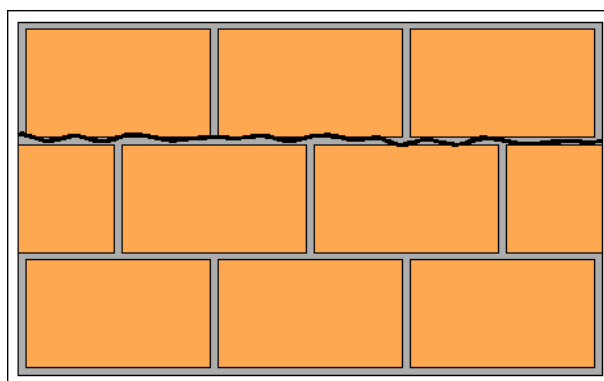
Fissuração horizontal devido ao esmagamento da argamassa
